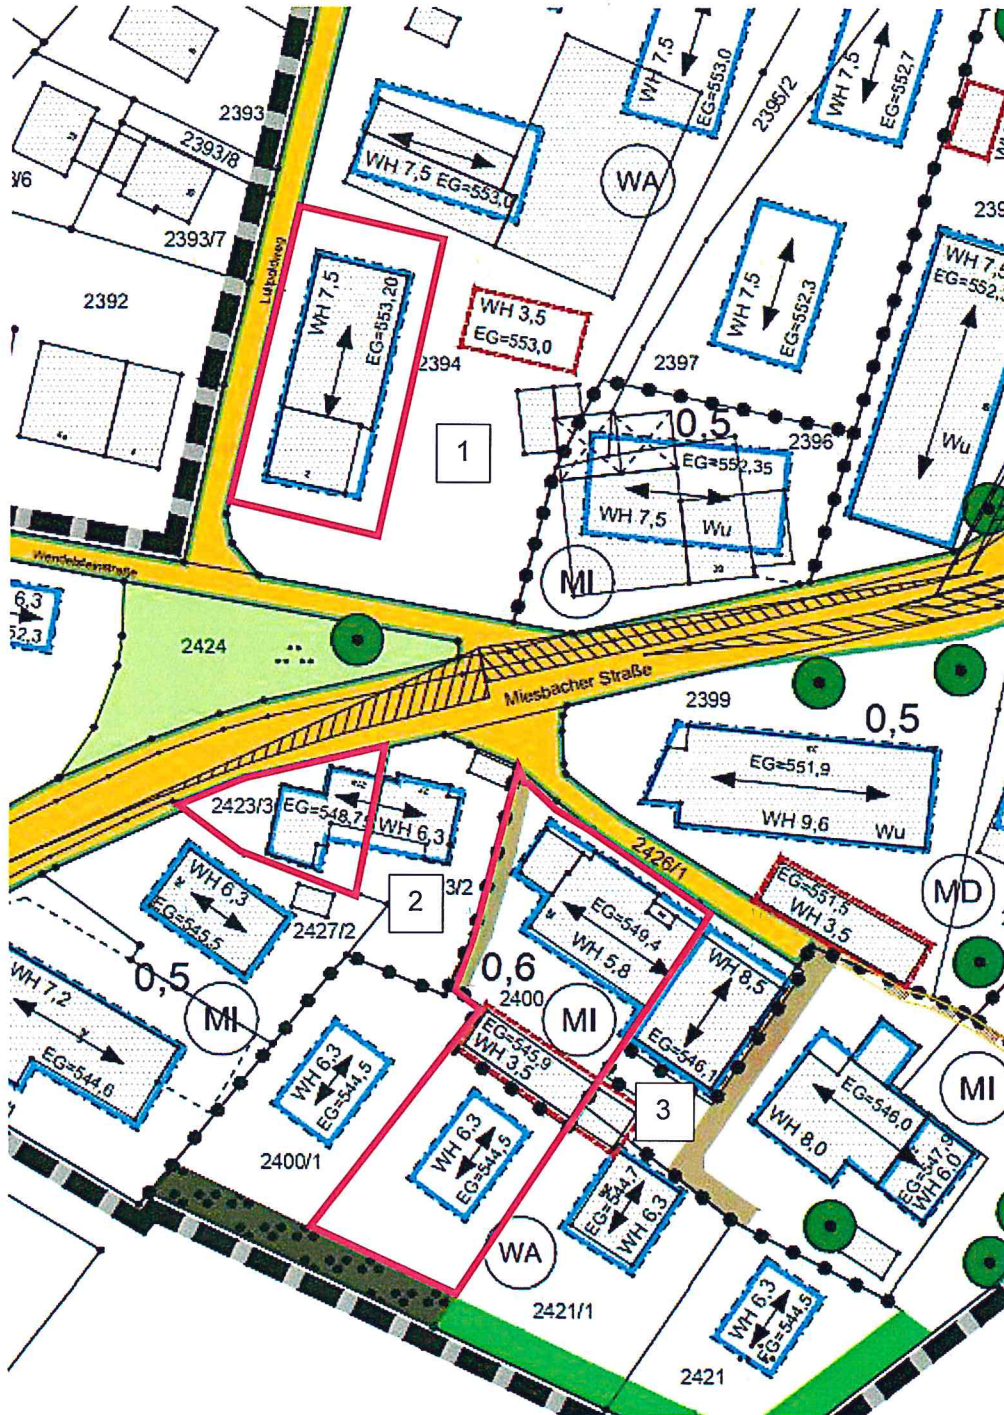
Urbauungsplan mit Änderungsbereichen, Quelle: Gemeinde Feldkirchen Westerham
